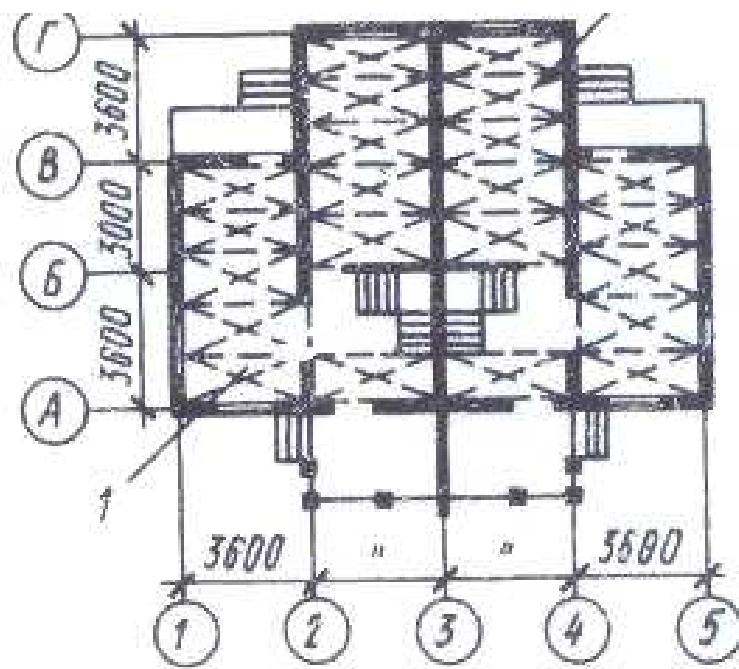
Схема с малым шагом поперечных несущих стен (1 – панели перекрытий)
